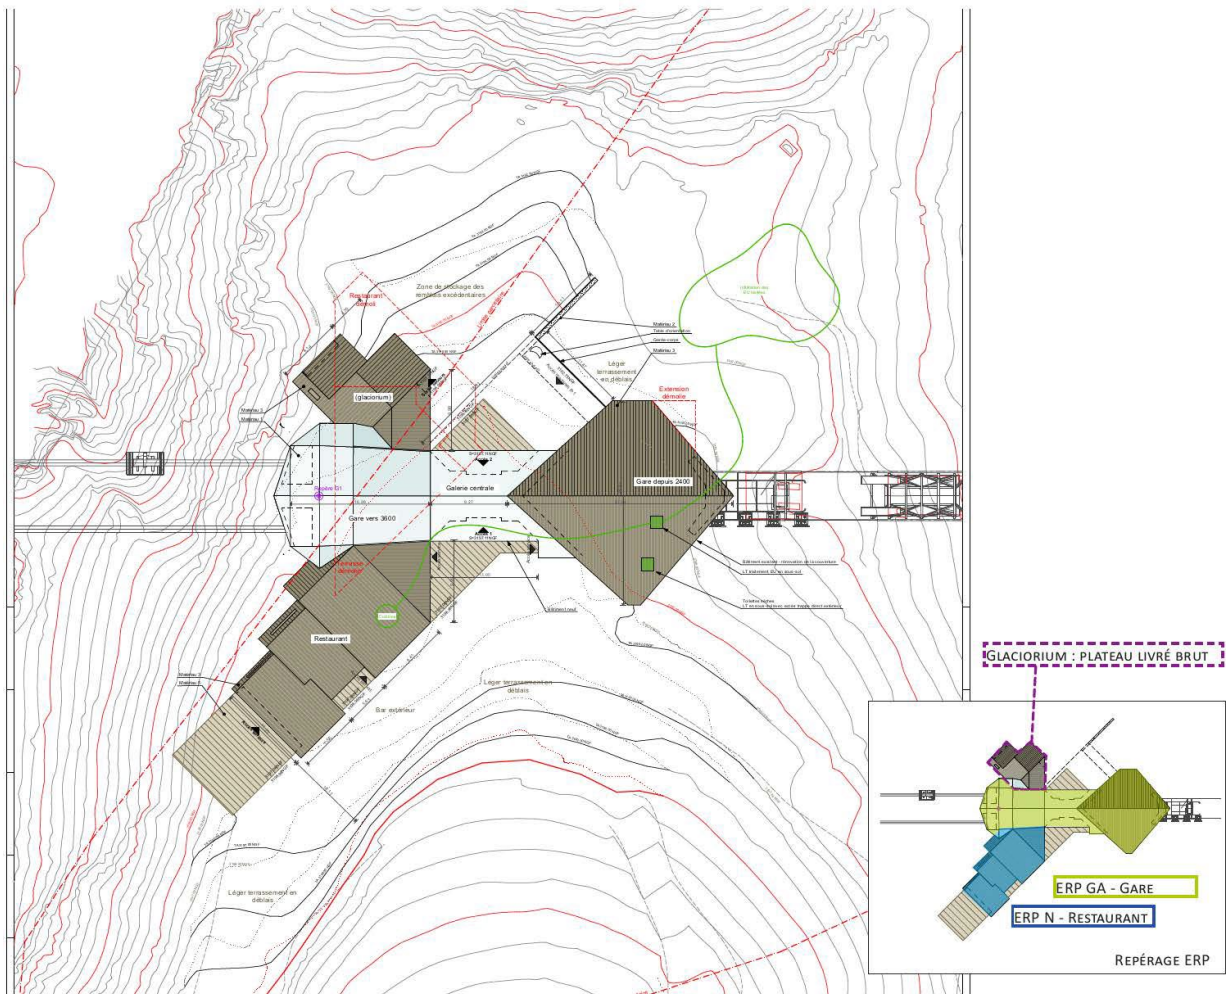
Plan des constructions projetées au col de Ruillans à 3 200 m - la gare 3600 est à 1 800 m en partant vers la gauche (source : dossier)
